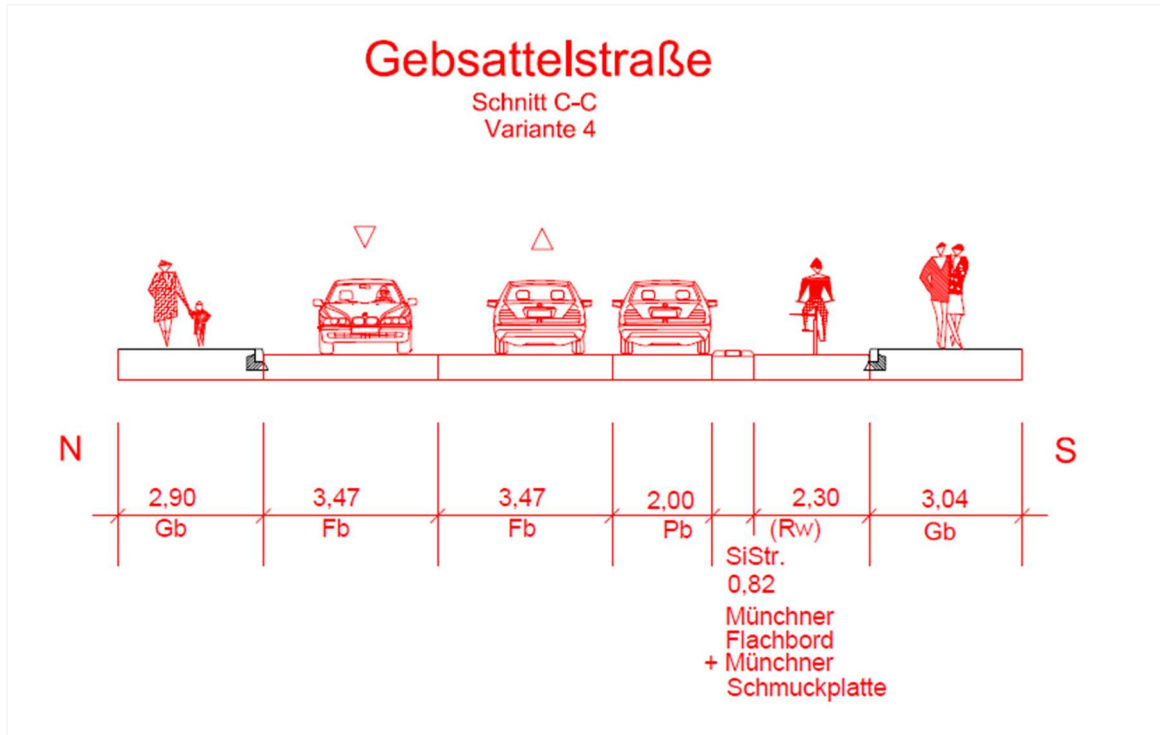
Querschnitt Planung Gebattelstraße auf Höhe Haus-Nr. 16 (Quelle: Ing.-Büro Kaltenecker).
